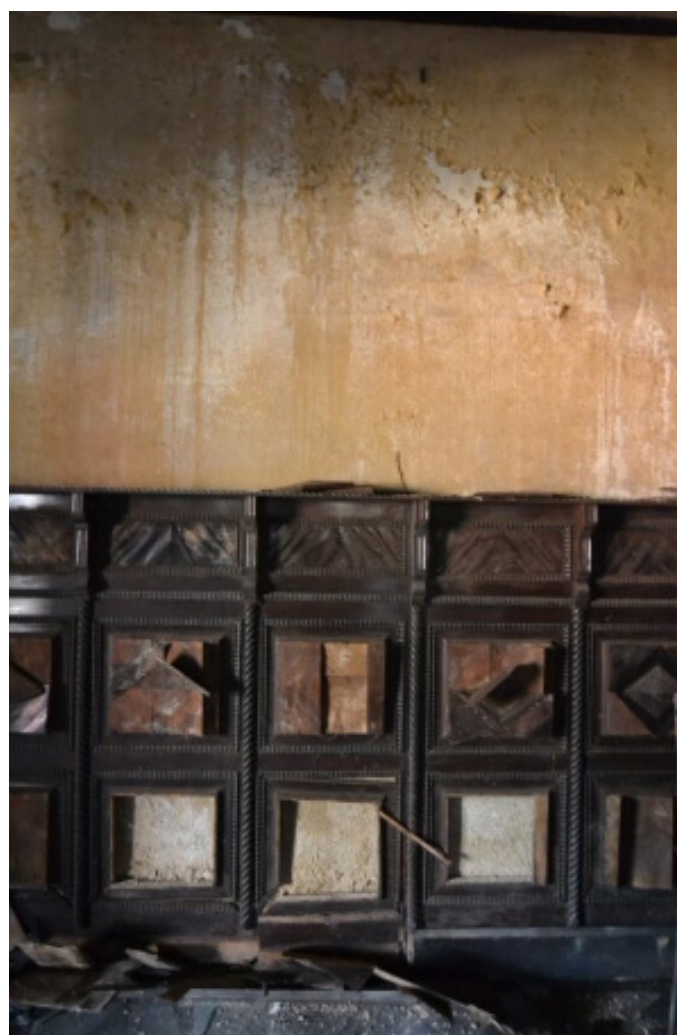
Detalhe da meia parede em painéis de madeira decorados e almofadados
